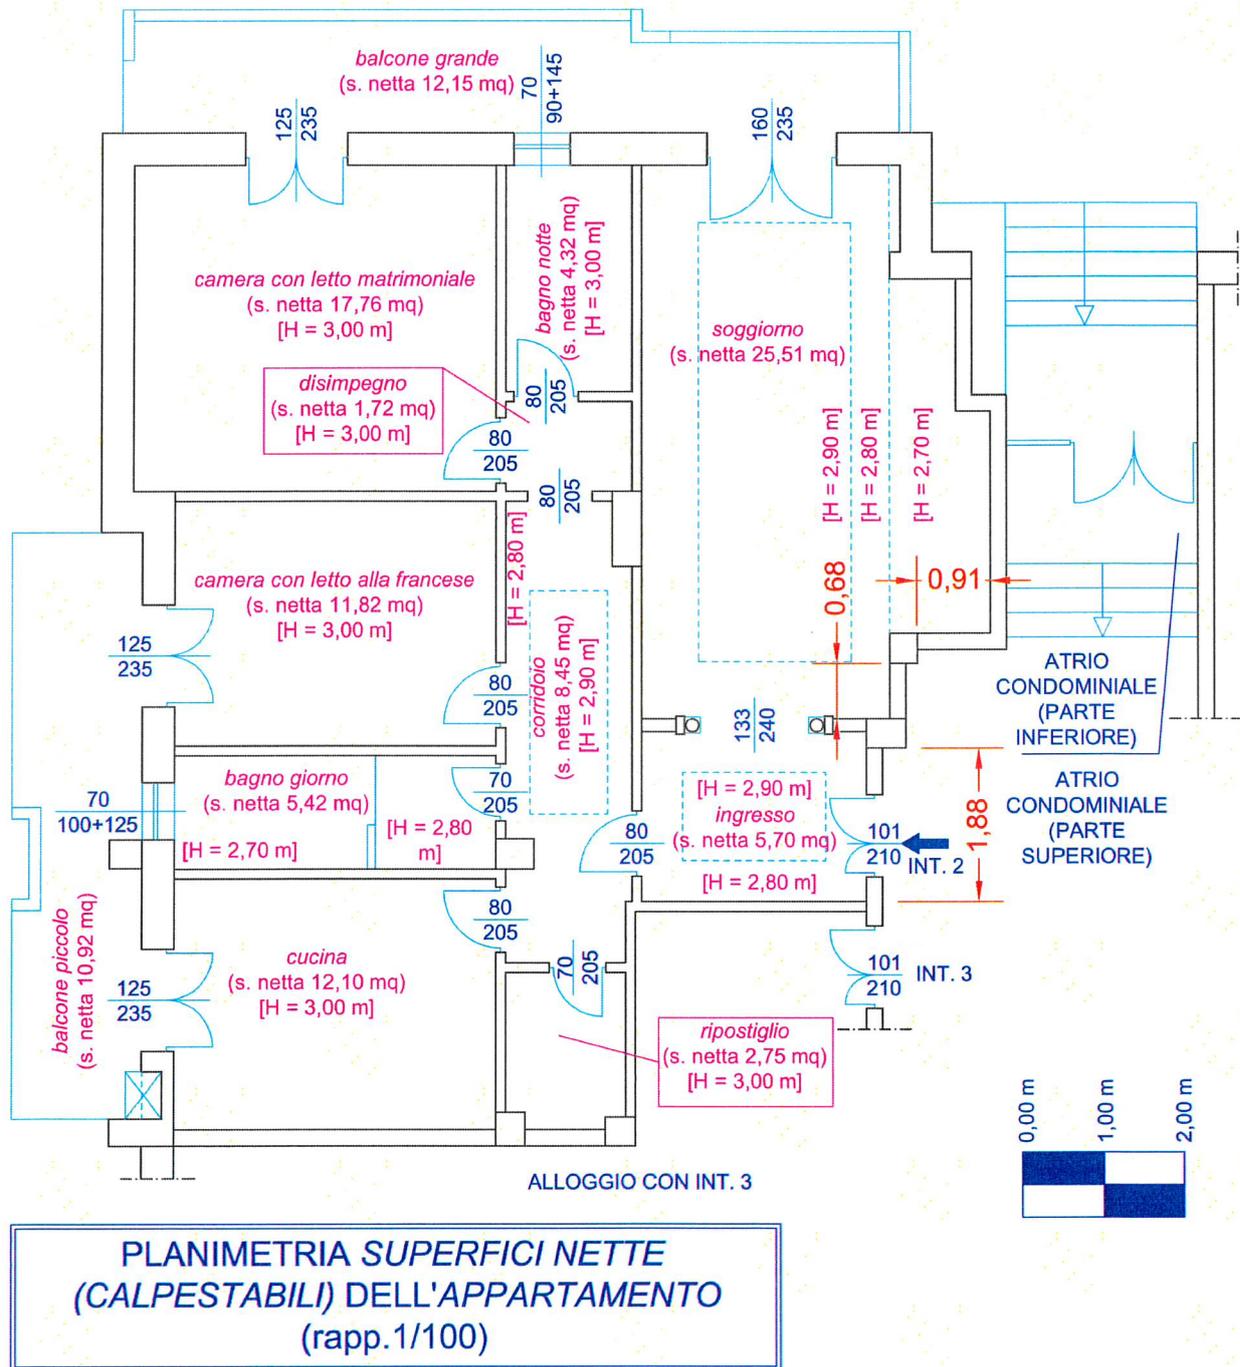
Planimetria urbanistica attuale delle superfici nette (calpestabili) dell'appartamento risalente al sopralluogo del 16.12.2022
